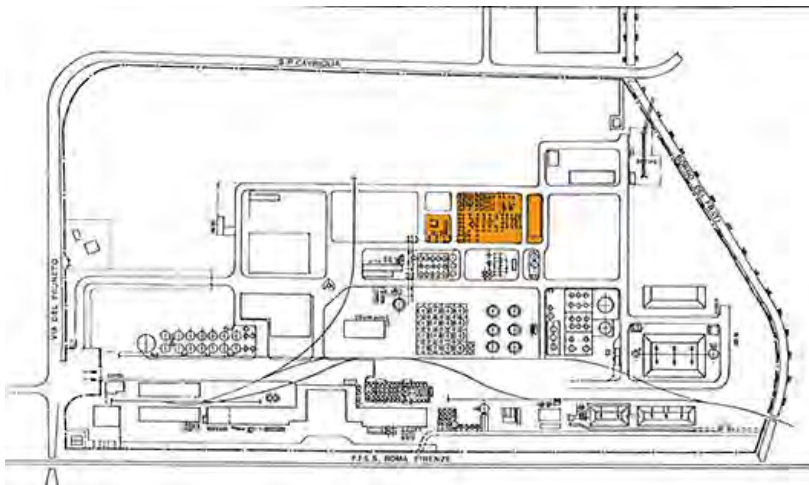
Planimetria Generale – Locazione Impianto Anidride Ftalica - Colore ARANCIO
